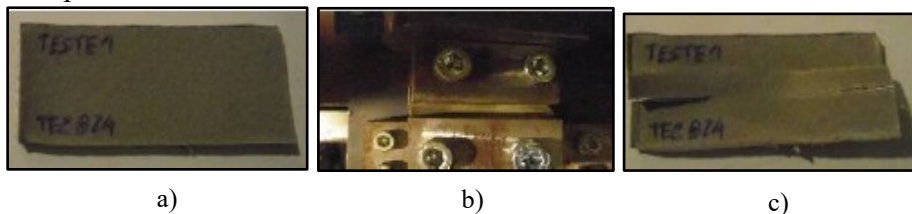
Torção tela Cimentícia s/ pré-corte: a) antes do ensaio, b) em ensaio, c) após o ensaio
